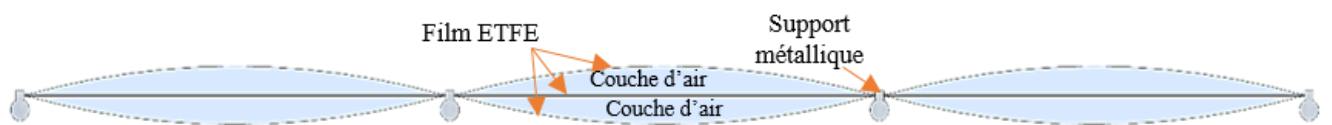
Coupe schématique d'un coussin ETFE triple couches
